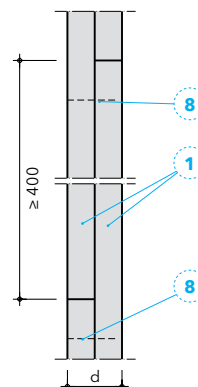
### Detail B - Pripojenie k ďalším deliacim prvkom alebo stavebnej konštrukcii
